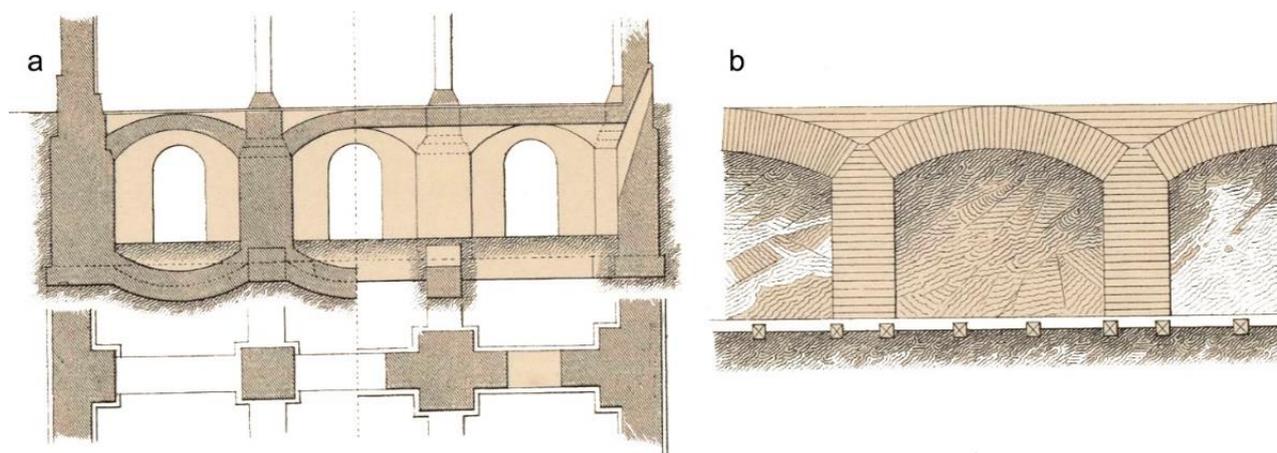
Отдельно стоящие (столбчатые) фундаменты: а – фундаментные столбы, объединенные опрокинутыми арками; б – столбчатый фундамент, объединенный сплошным ростверком в уровне подошвы строения [12]
